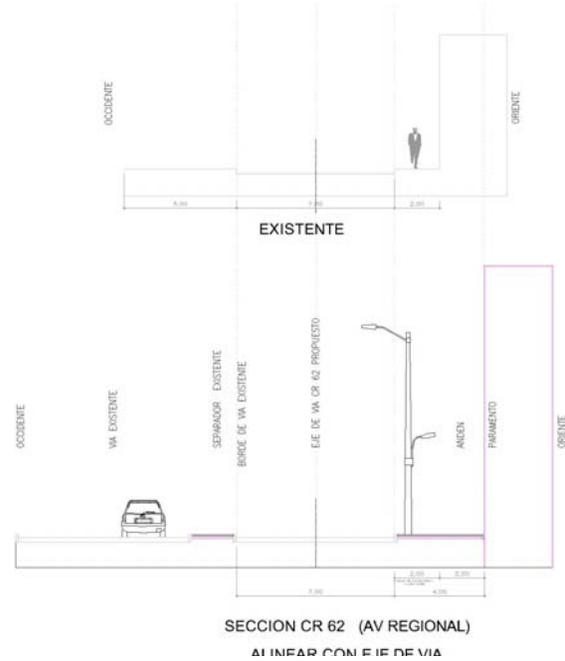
Sección existente y propuesta para carrera 62, Av.
